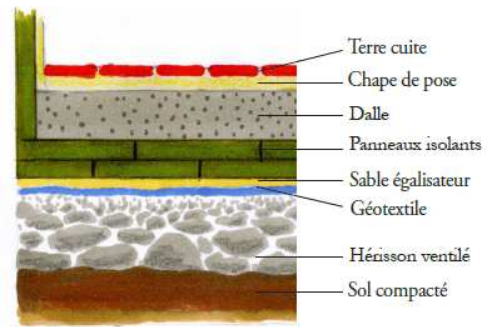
schéma technique dalle isolée sur hérissseon ventilé
